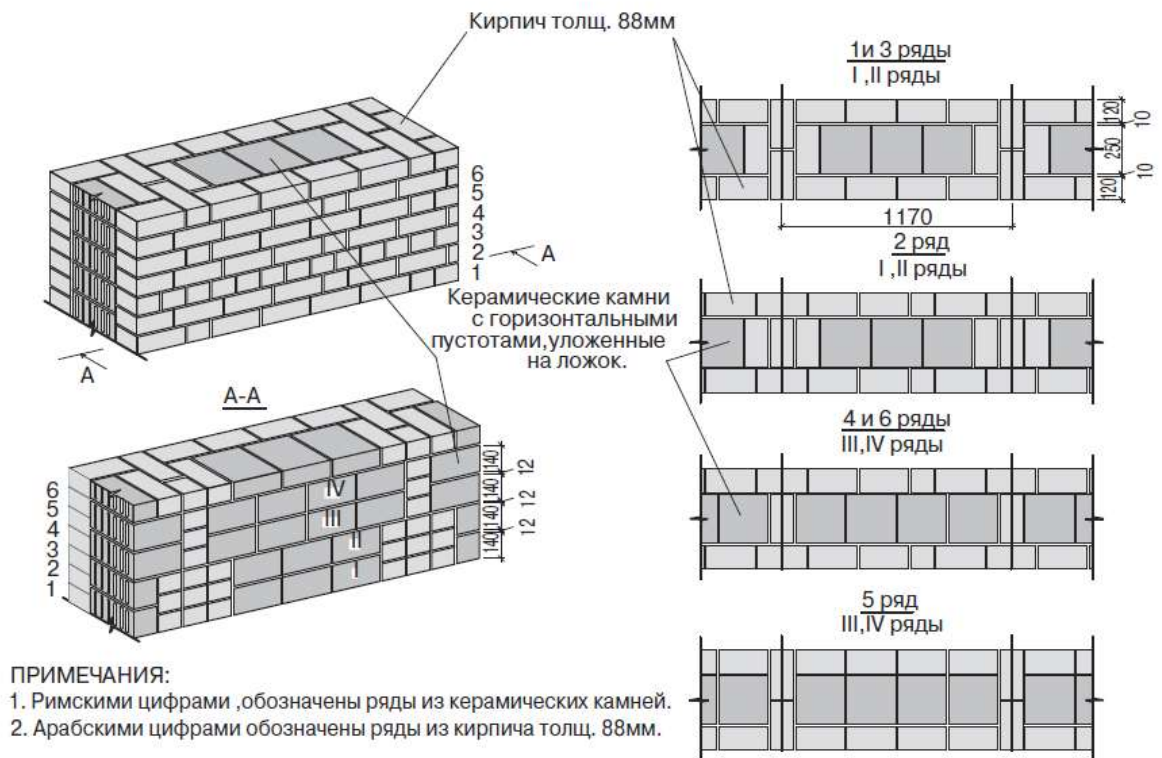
Примеры технических решений стен из комбинированной кладки с внутренним слоем из 11-пустотных керамических камней с горизонтальным расположением пустот и внешними слоями из кирпича с вертикальными пустотами. 1986 г.
